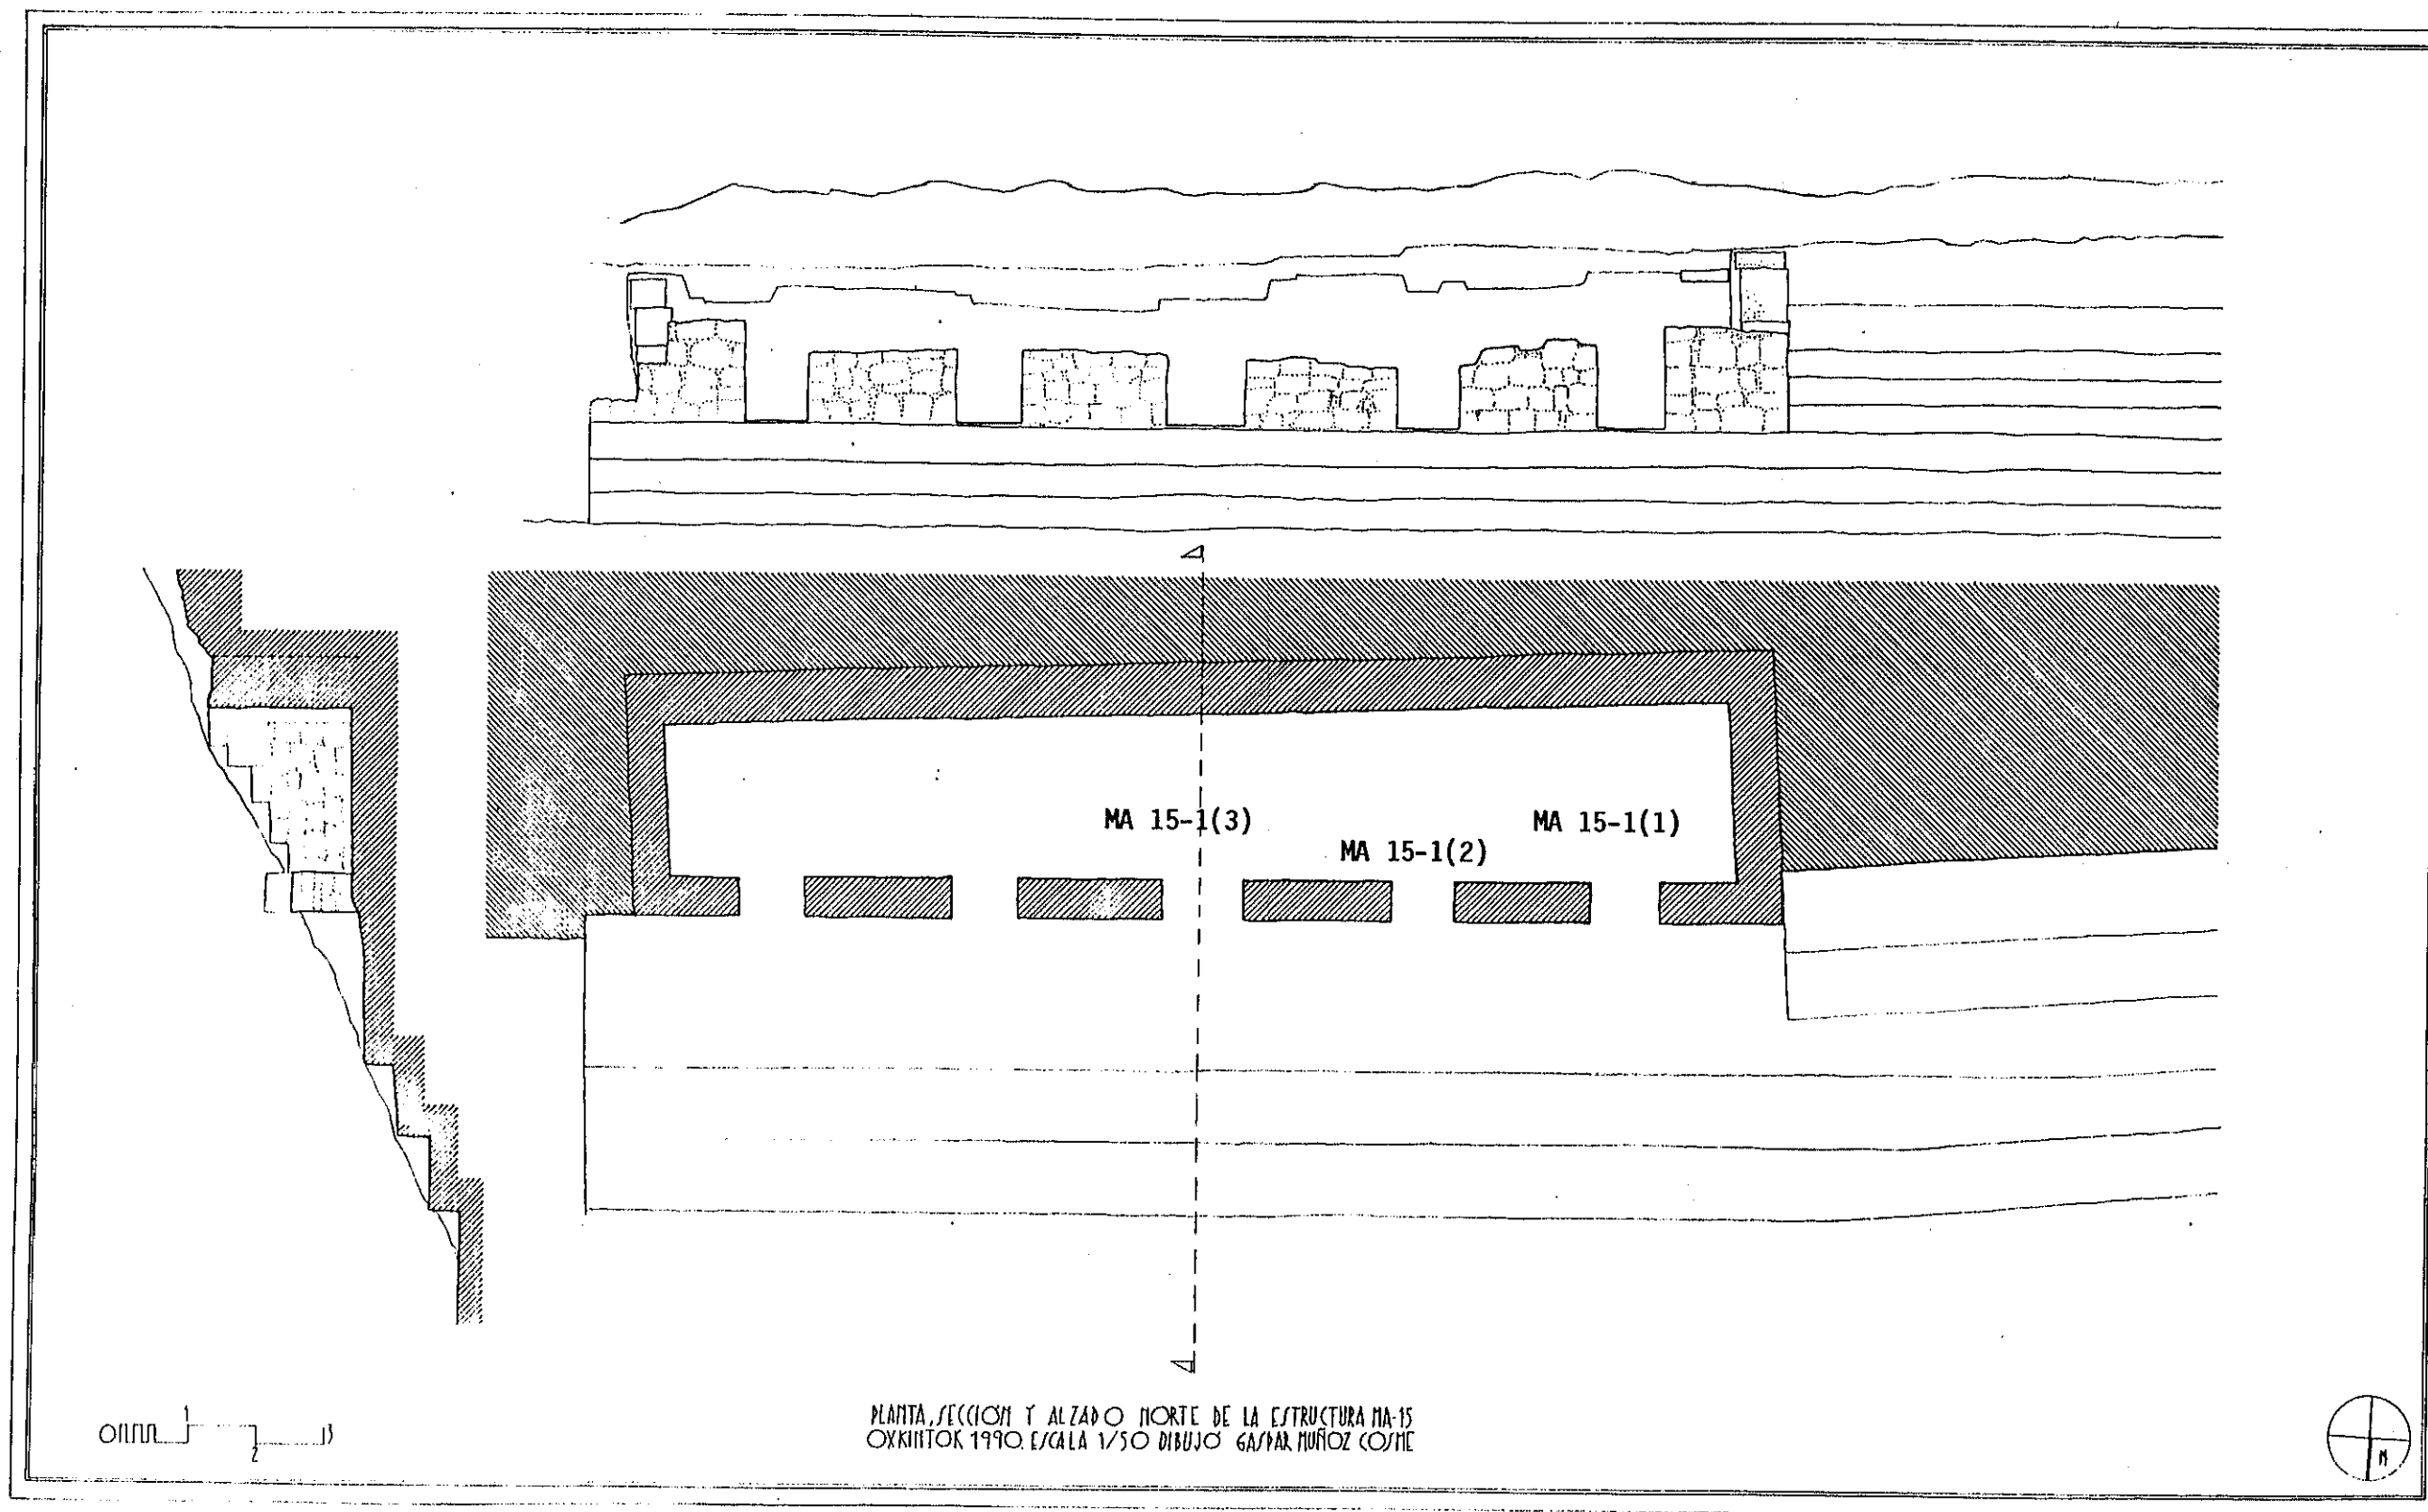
Planta, sección y alzado de la estructura MA-15. Aparecen señaladas las tres suboperaciones realizadas en el interior de la estructura.
